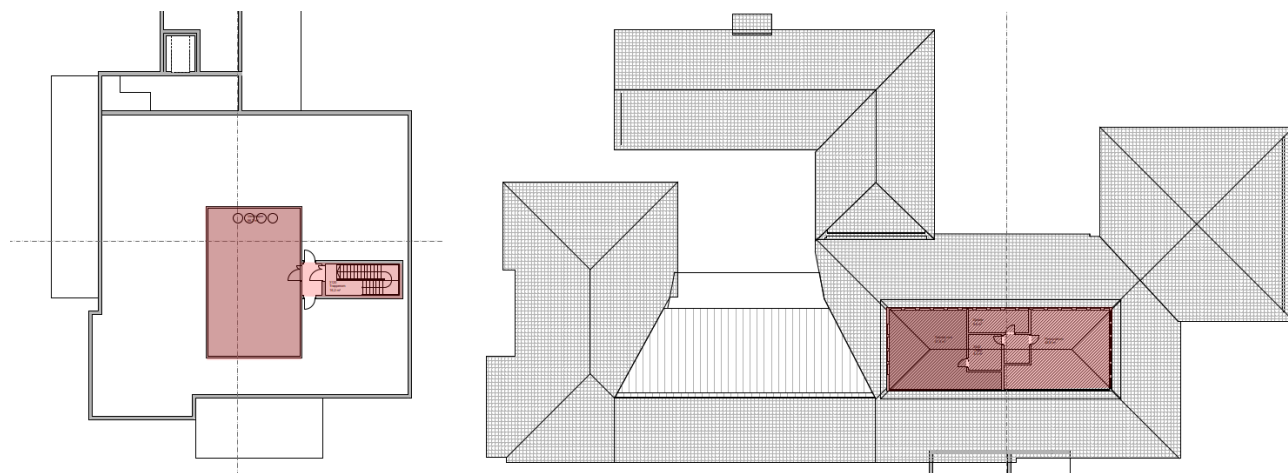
Nybygg plan U (venstre) og plan 1 (høyre). Plan 2 er forutsatt tilsvarende plan 1. Oversikt over forutsatt tilsiktet temperatur plan U (venstre) og plan 1 og 2 (høyre). Rødt markert areal = fullt oppvarmet, grønt areal = kjølerom, blått areal = uoppvarmet (frostsikringstemperatur 5 °C).
